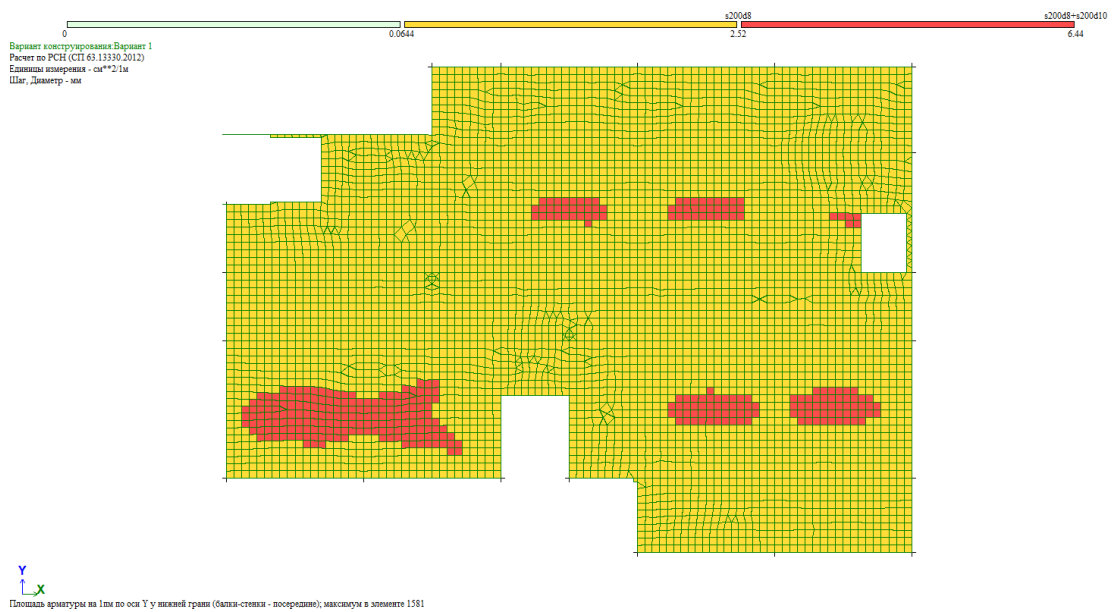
Площадь арматуры на 1м по Y у нижней грани
